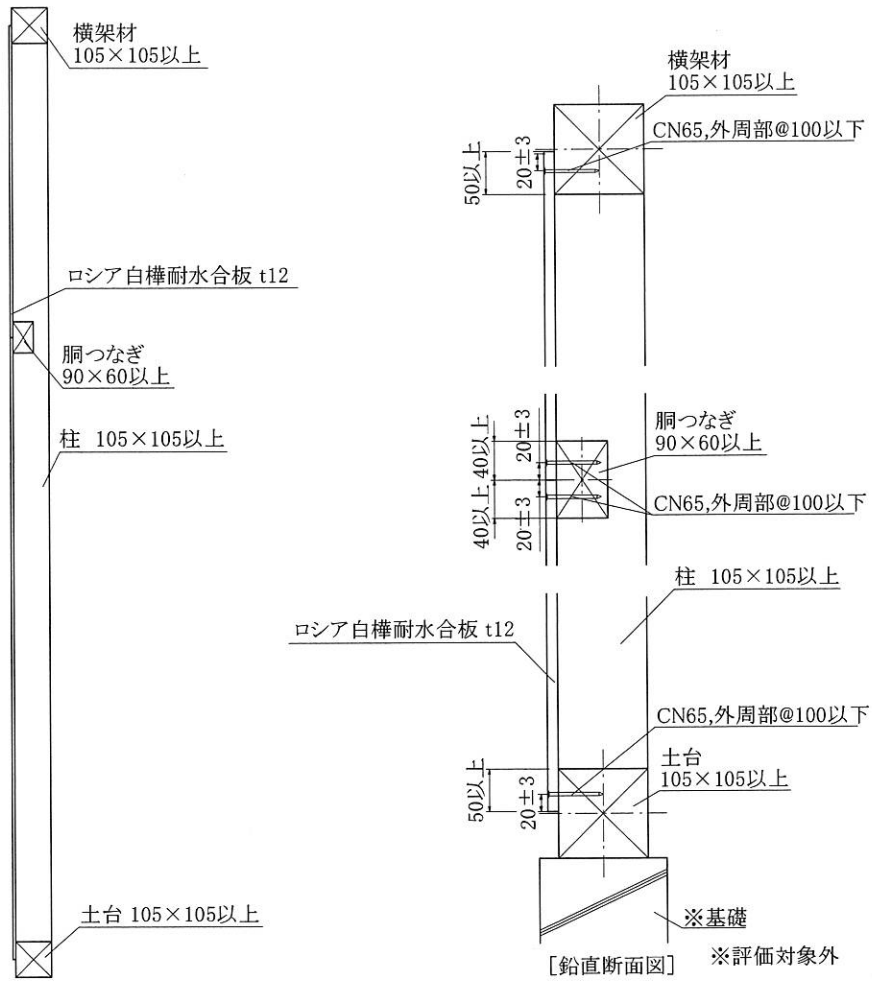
施工図 [鉛直断面] (寸法単位 : mm)
